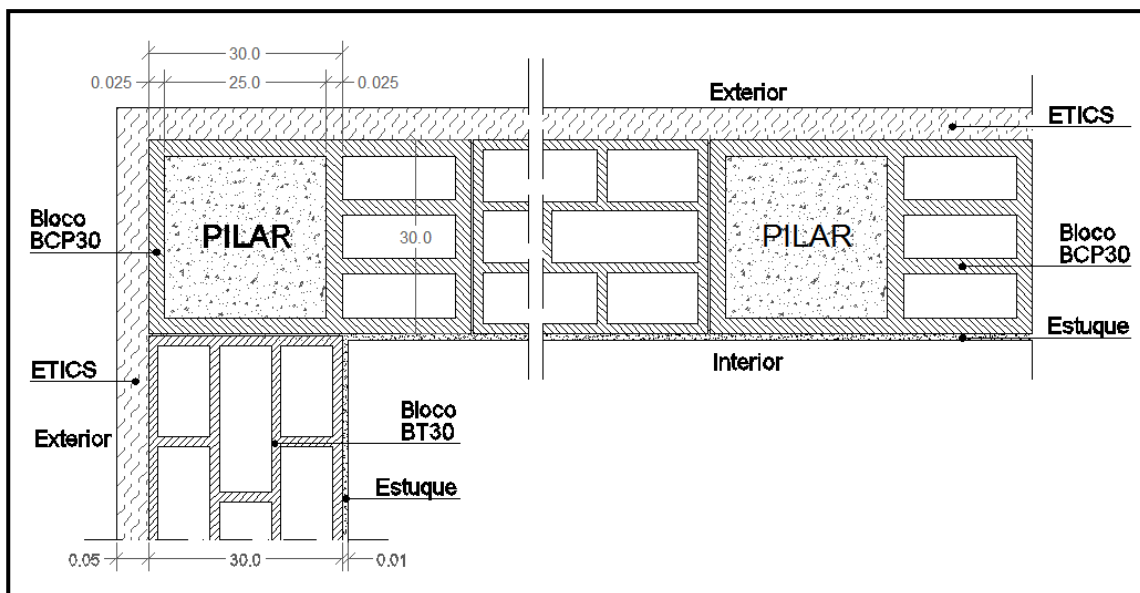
Pormenor da parede exterior e viga, em corte (Pe1)
